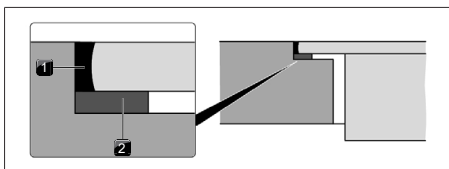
Cinta selladora en caso de montaje enrasado
